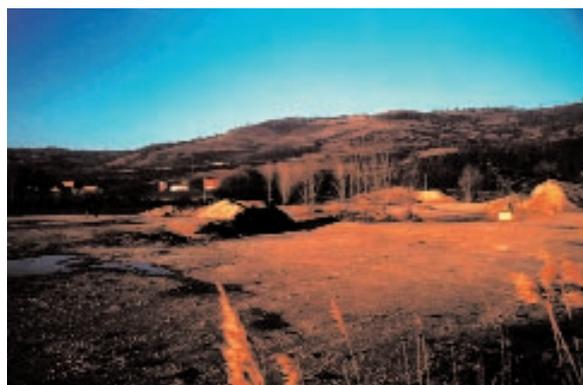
Vista panoramica dell'area prima dell'intervento.
